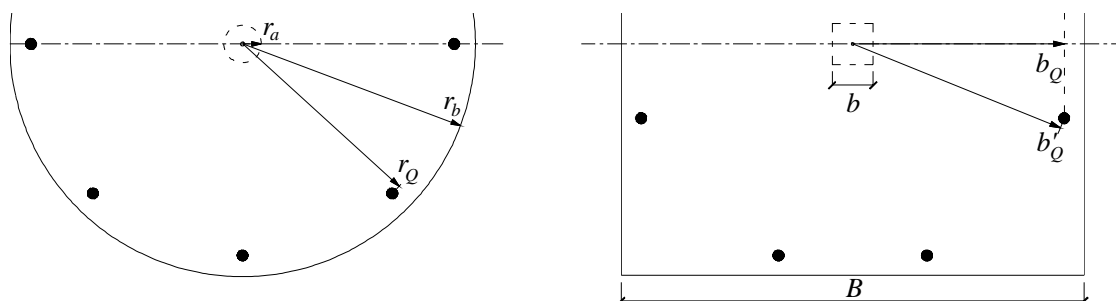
Géométrie d'une dalle d'essai circulaire et d'une dalle d'essai carrée
